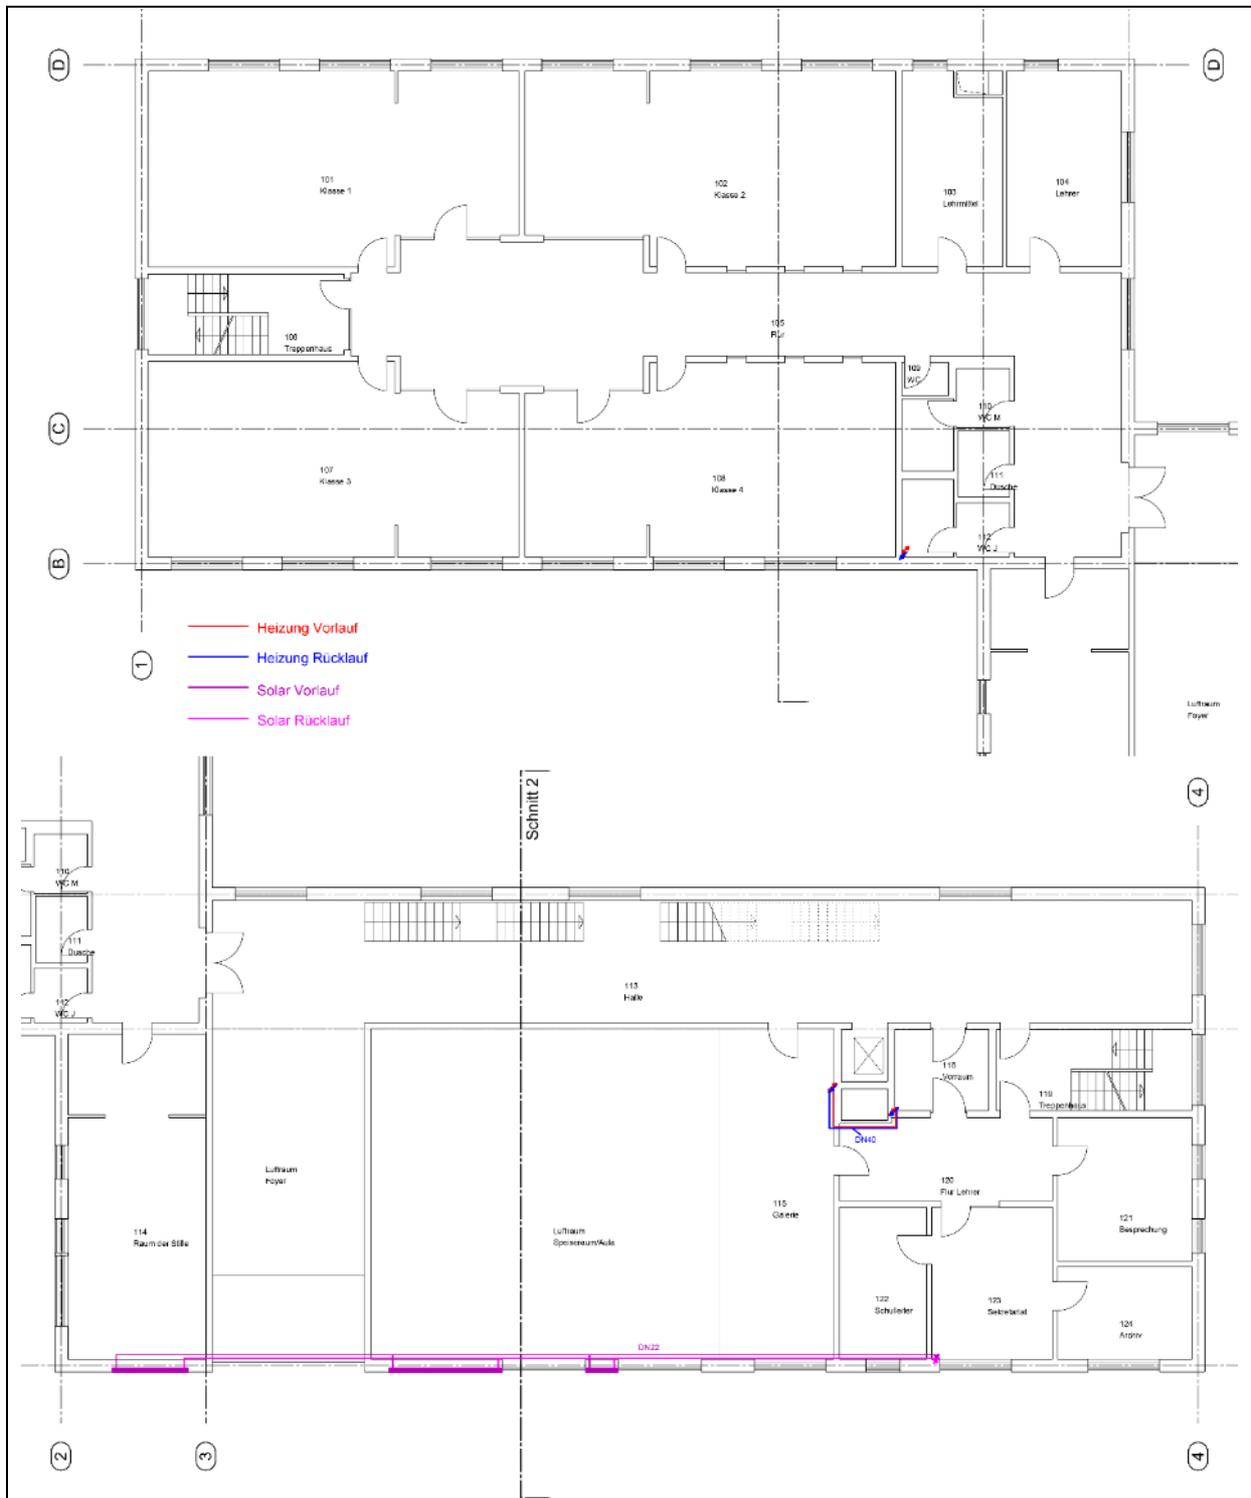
Grundriss Heizung – 1. Obergeschoss – BTA (unten) und BTB (oben) [3]
